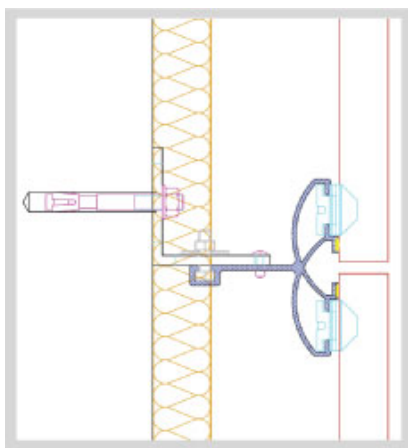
Aplicação da fachada ventilada – Detalhe horizontal da solução [47]
